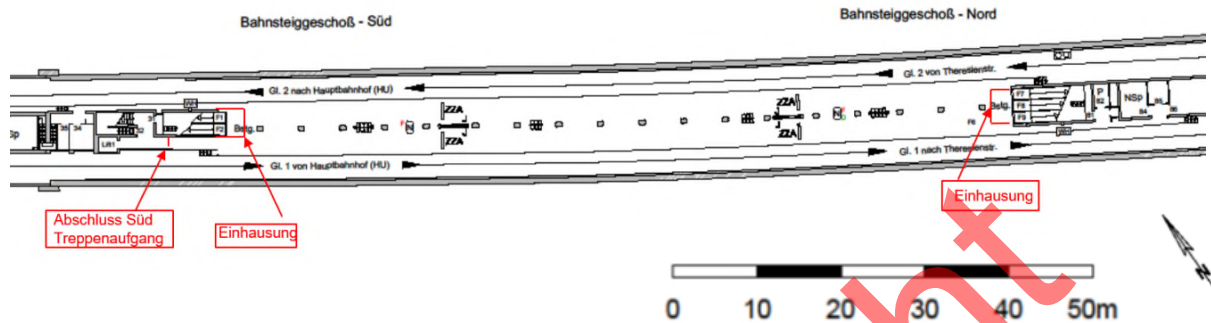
Grundriss Bahnsteiggeschoss, Einhausungen, Abschluss Treppenaufgang
